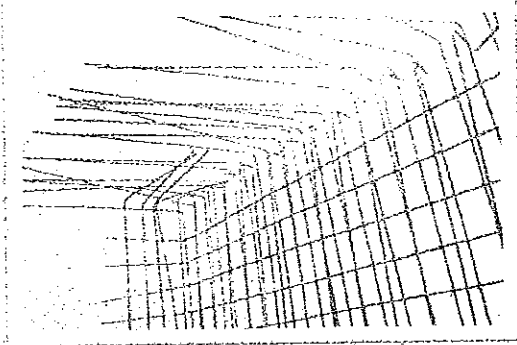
, 54: armado de los muros laterales, armado de la placa superior.
